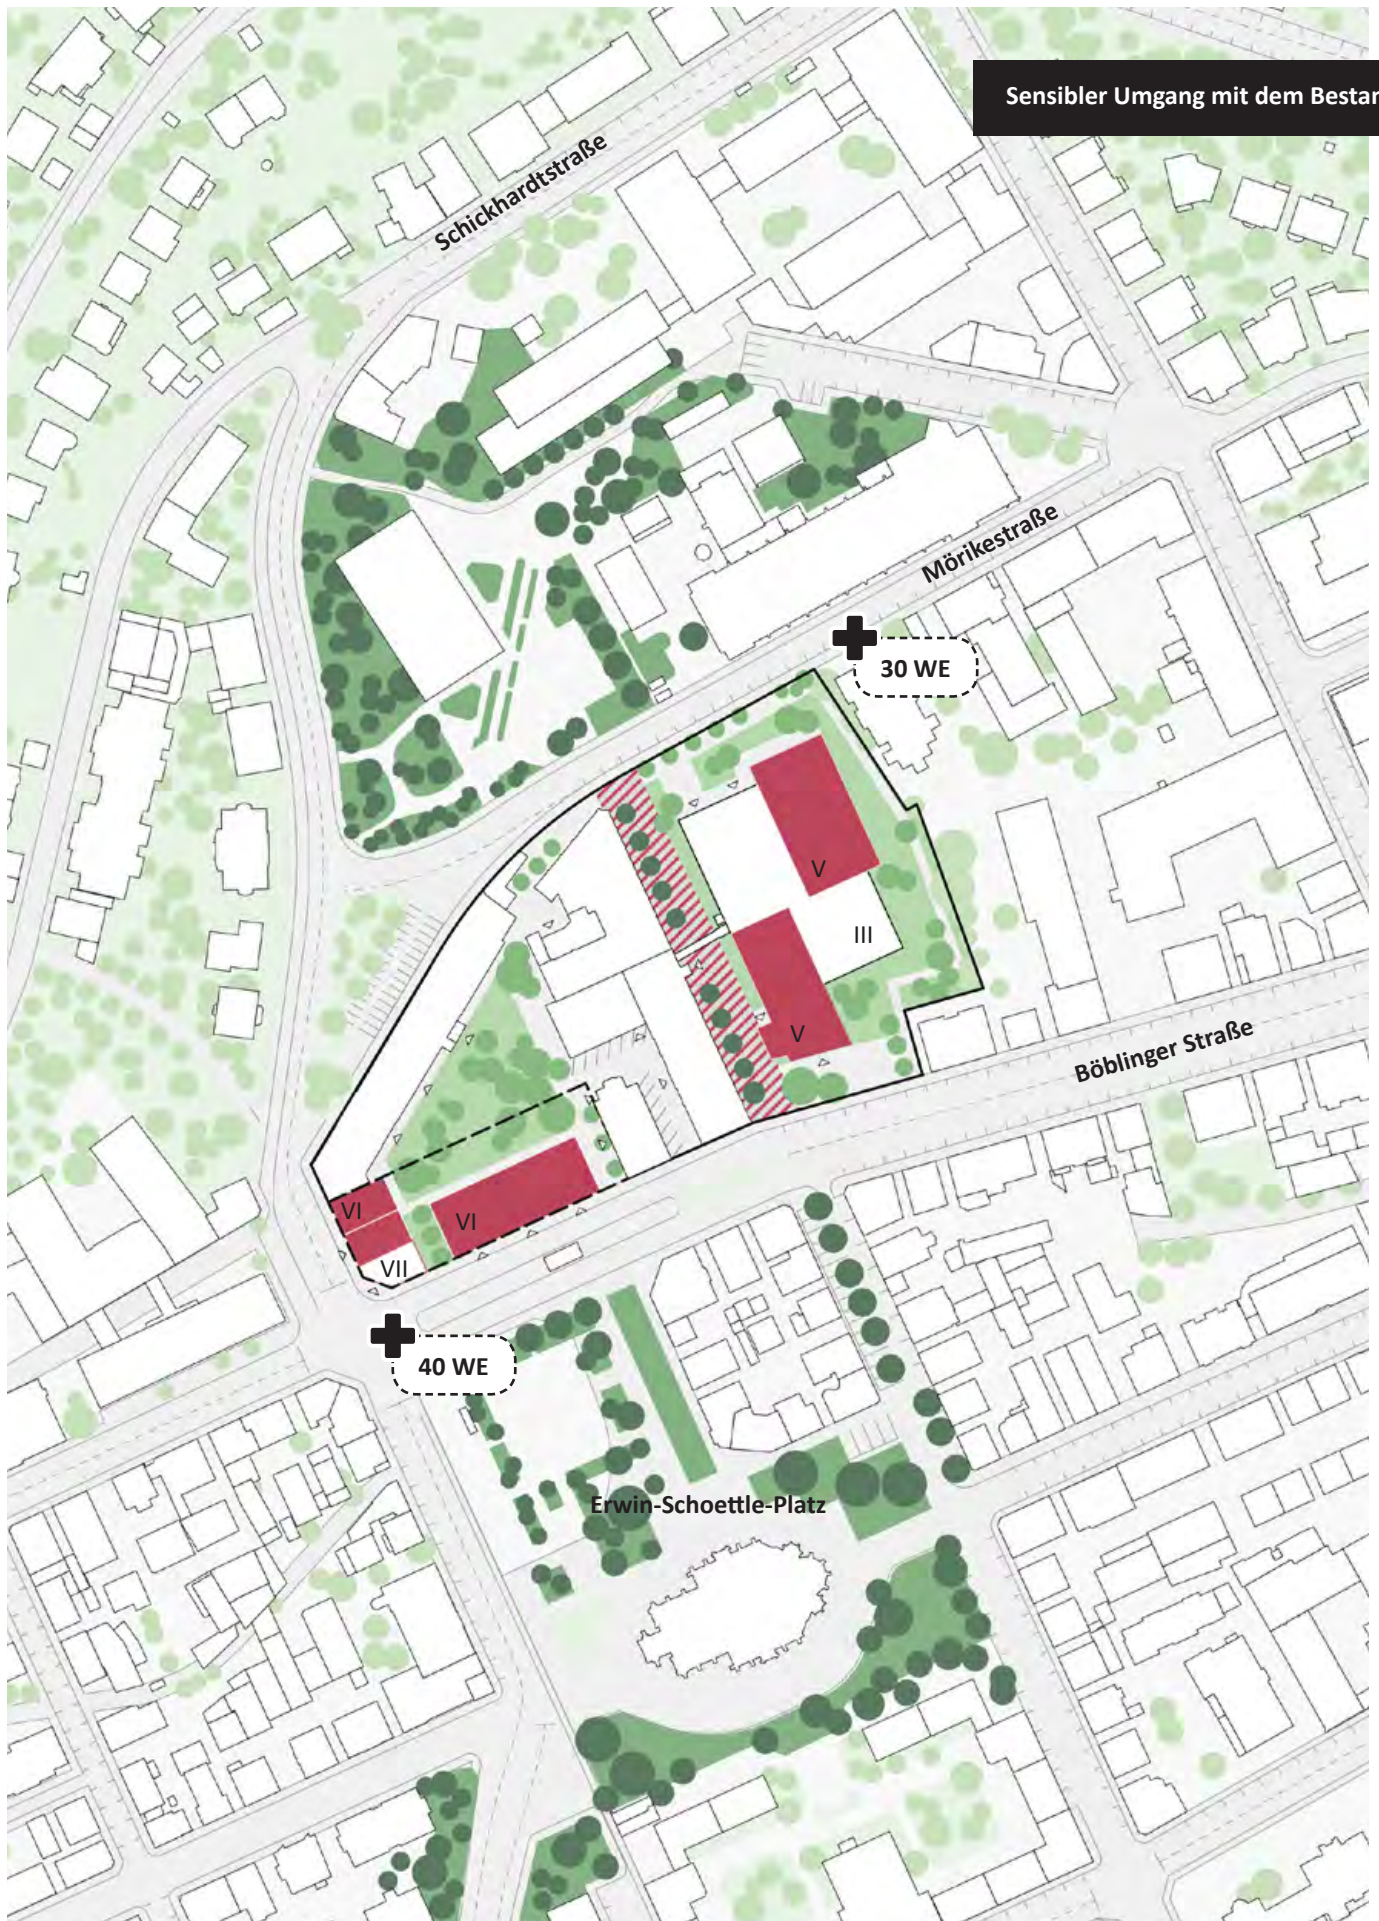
Lageplan der Bebauungsvariante zum Erhalt des Bestandes
